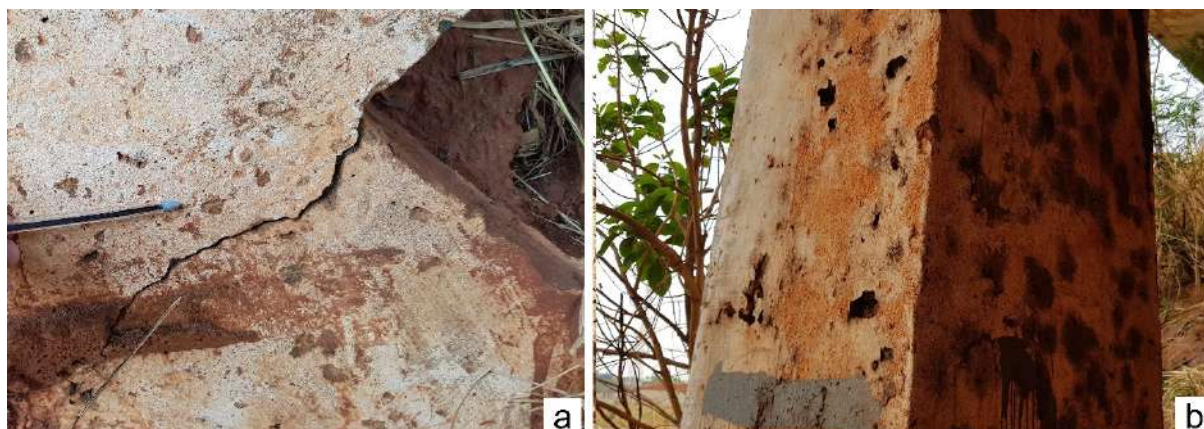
(a) Fissuras no viaduto (b) ninhos de concretagem
